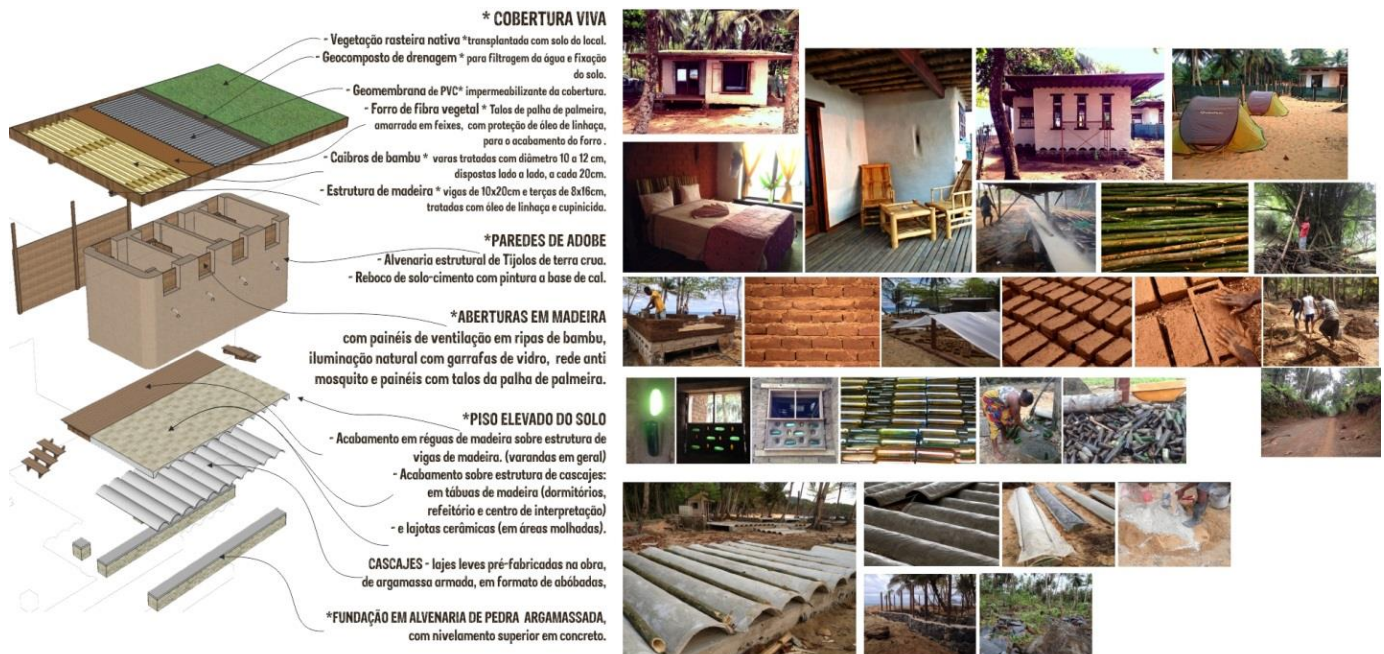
Perspectiva explodida e fotos do sistema construtivo e
